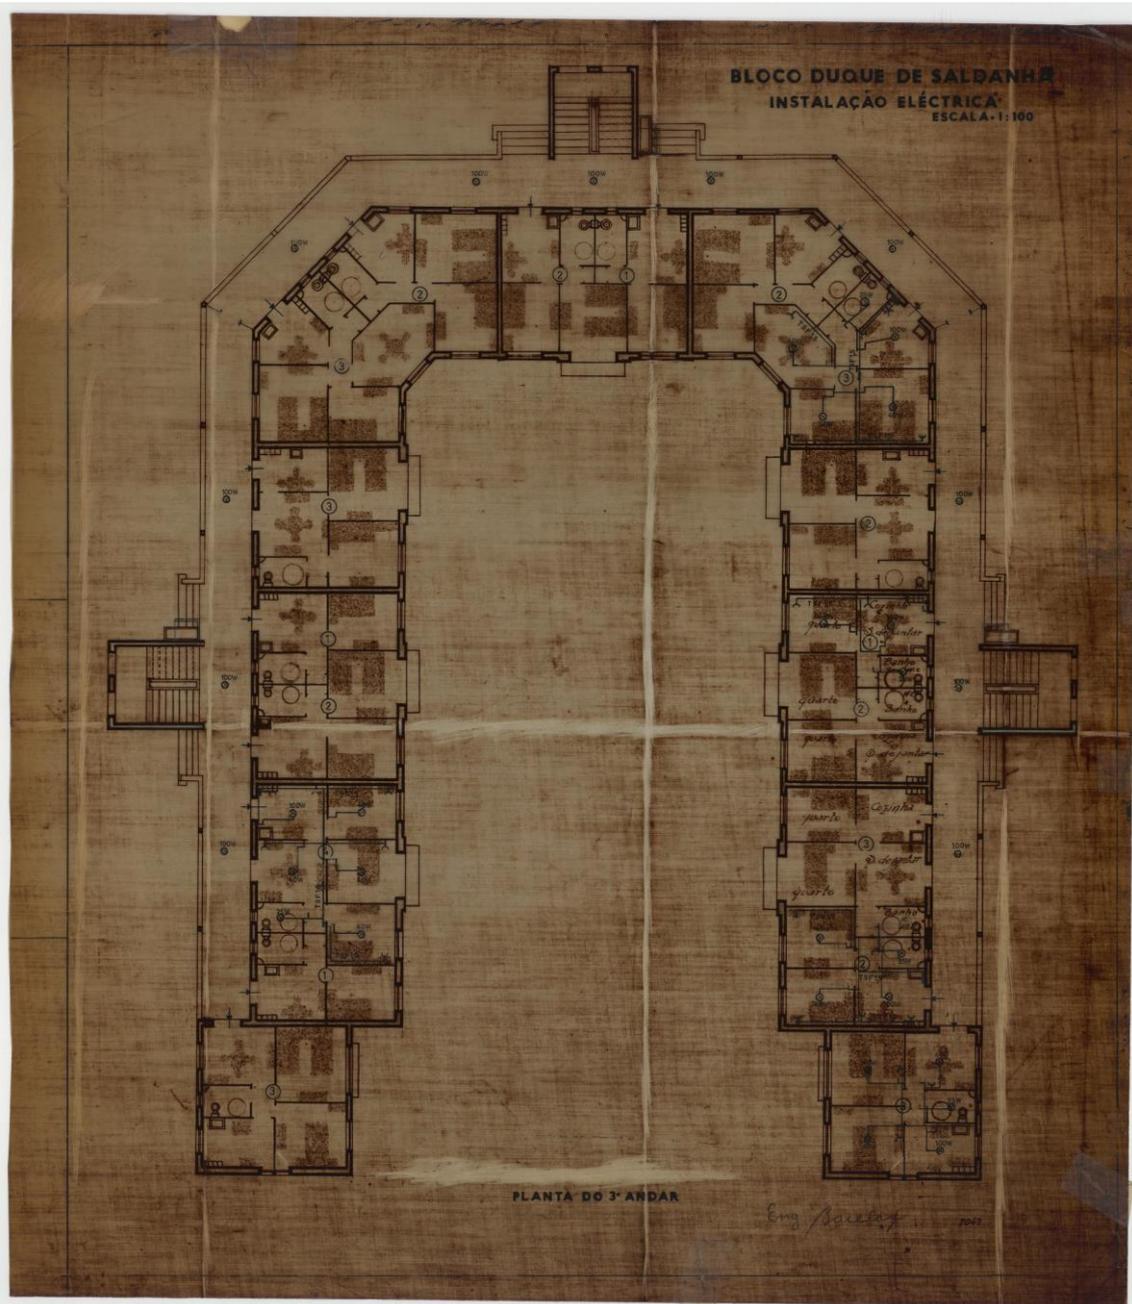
Planta do terceiro piso do bairro do Duque de Saldanha.
